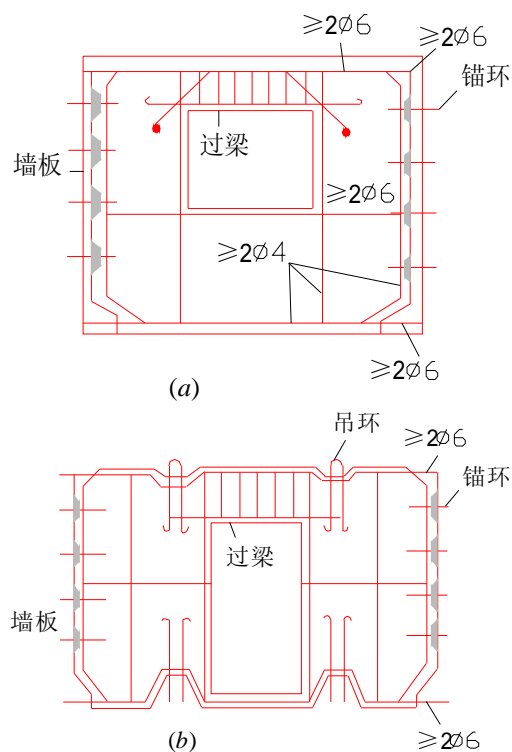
少筋混凝土墙板、轻集料和粉煤灰混凝土墙板、振动
